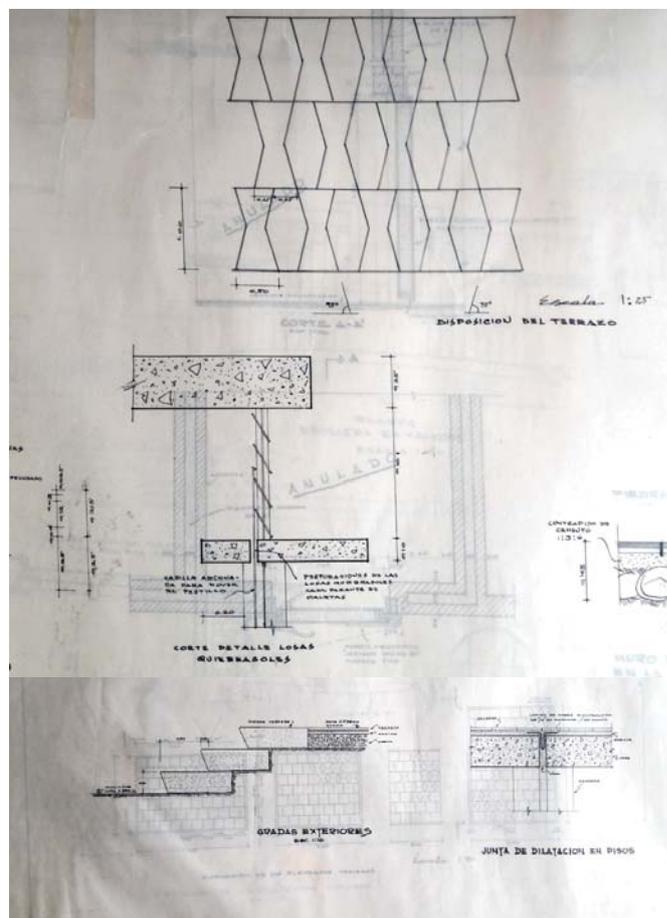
Fotografía del planos estructurales del volúmen de circulación bloque construido.
